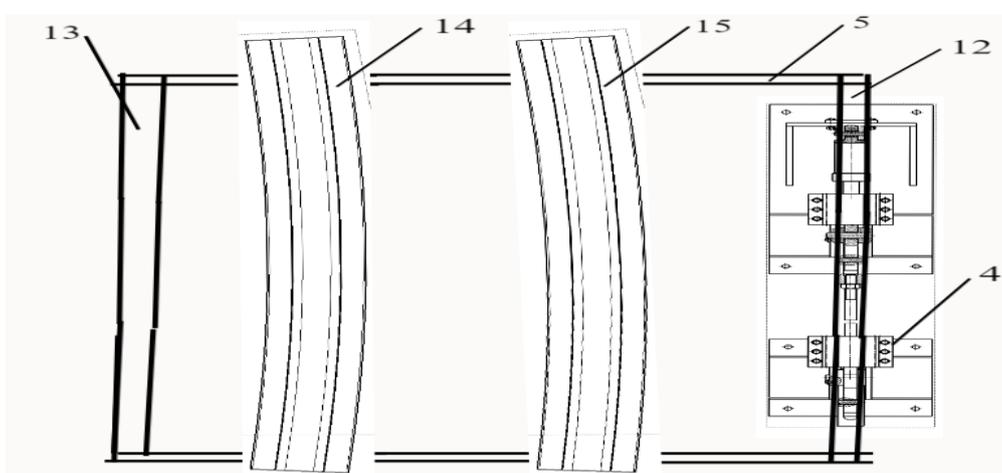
Общий вид стенда сверху с размещением на основании рельсового блока
